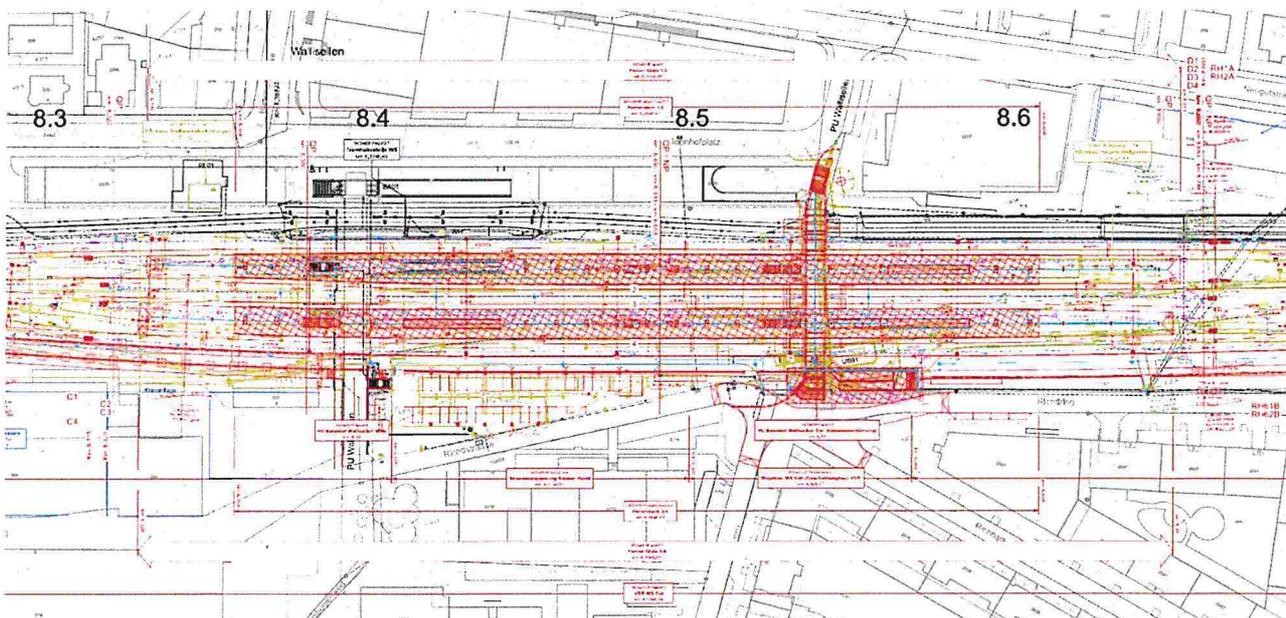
Übersichtsplan Bahnhof Wallisellen mit Umbauten gemäss Auflageprojekt MehrSpur
